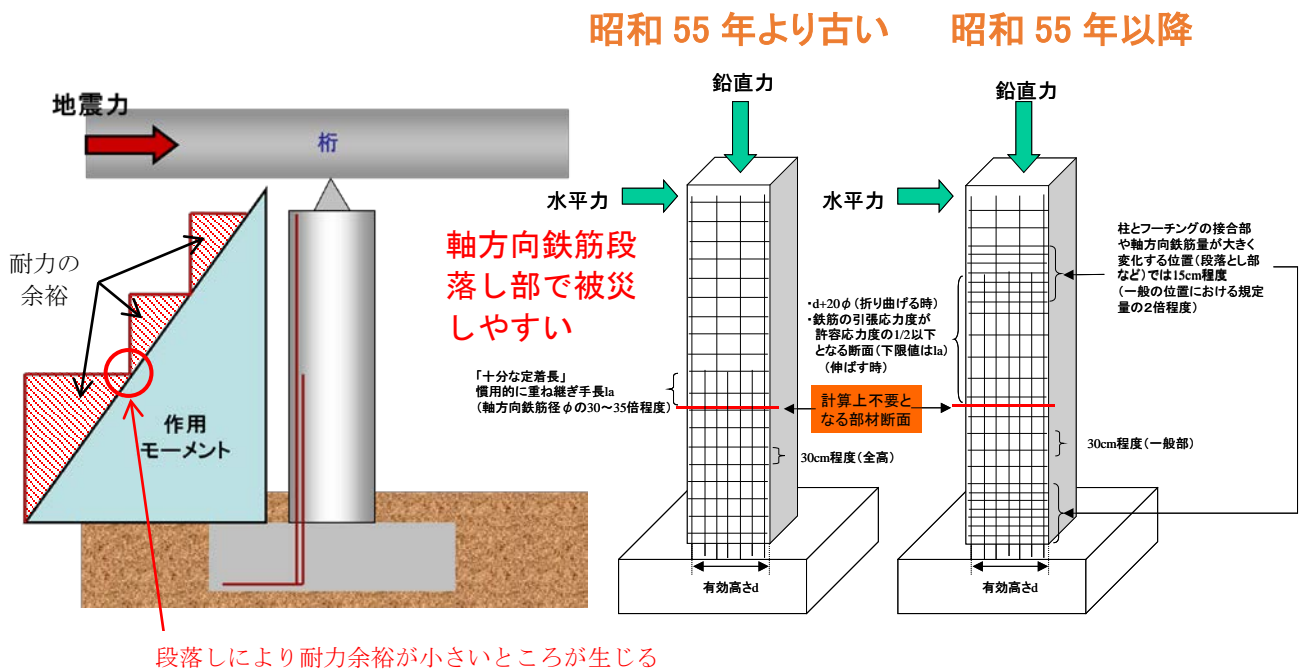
地震による鉄筋コンクリート橋脚段落し部の損傷
